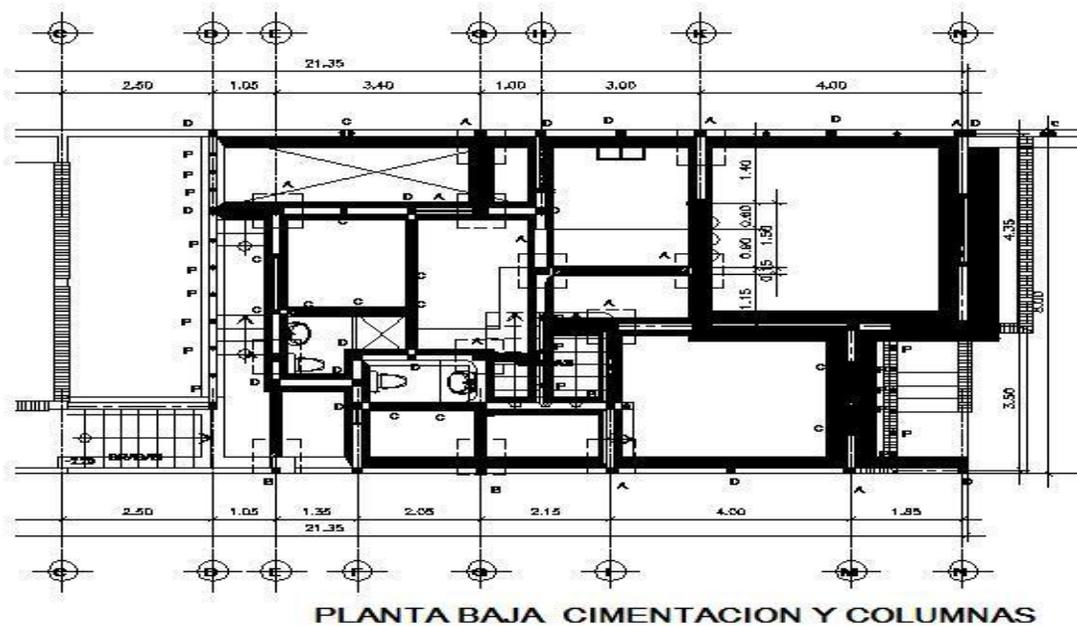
PLANO DE ESTRUCTURAS DEL PROYECTO. FUENTE: Proyecto de Construcción Vivienda Familiar, señor Mauricio Catalán
